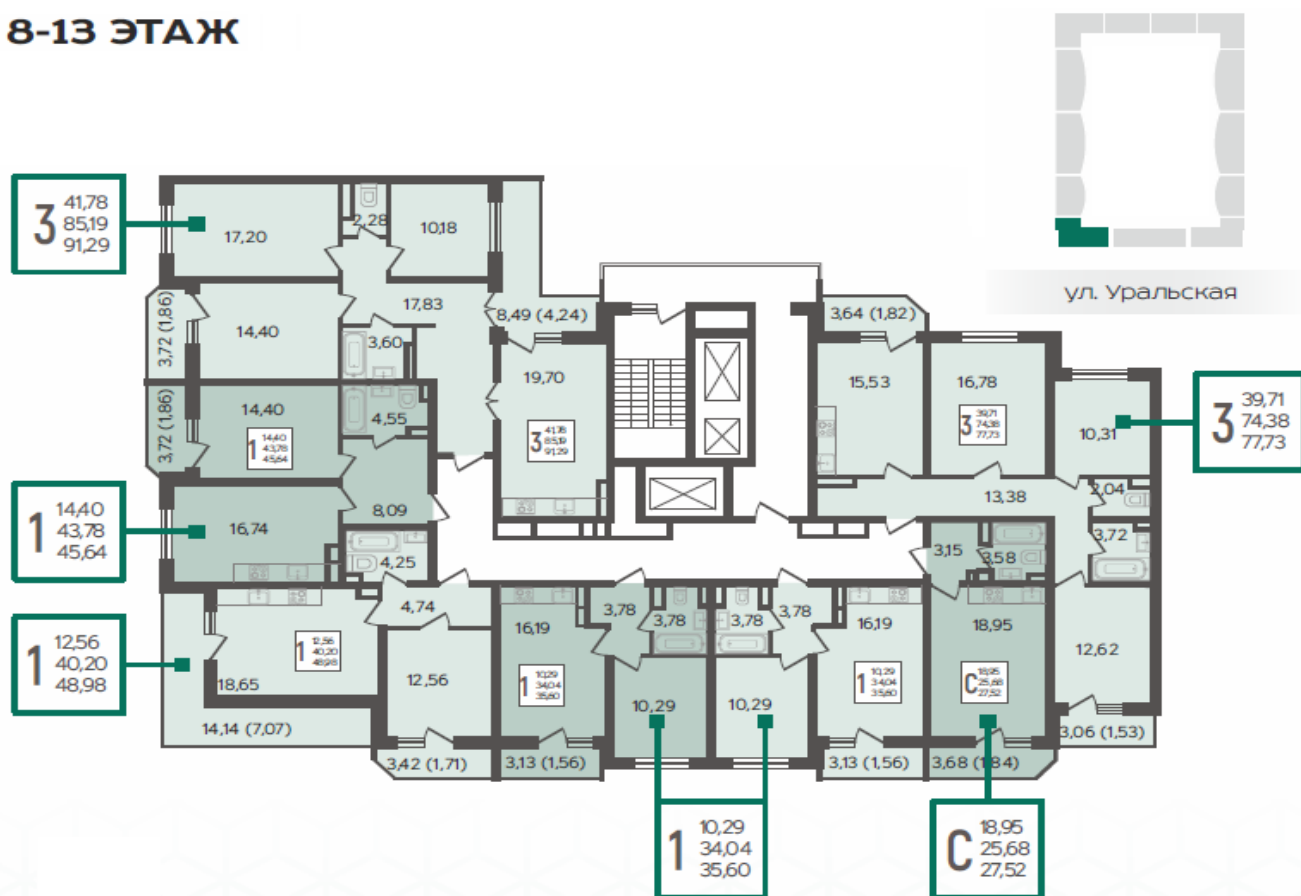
Типовой план 8-13 этажа БС-1 ЖК URAL
